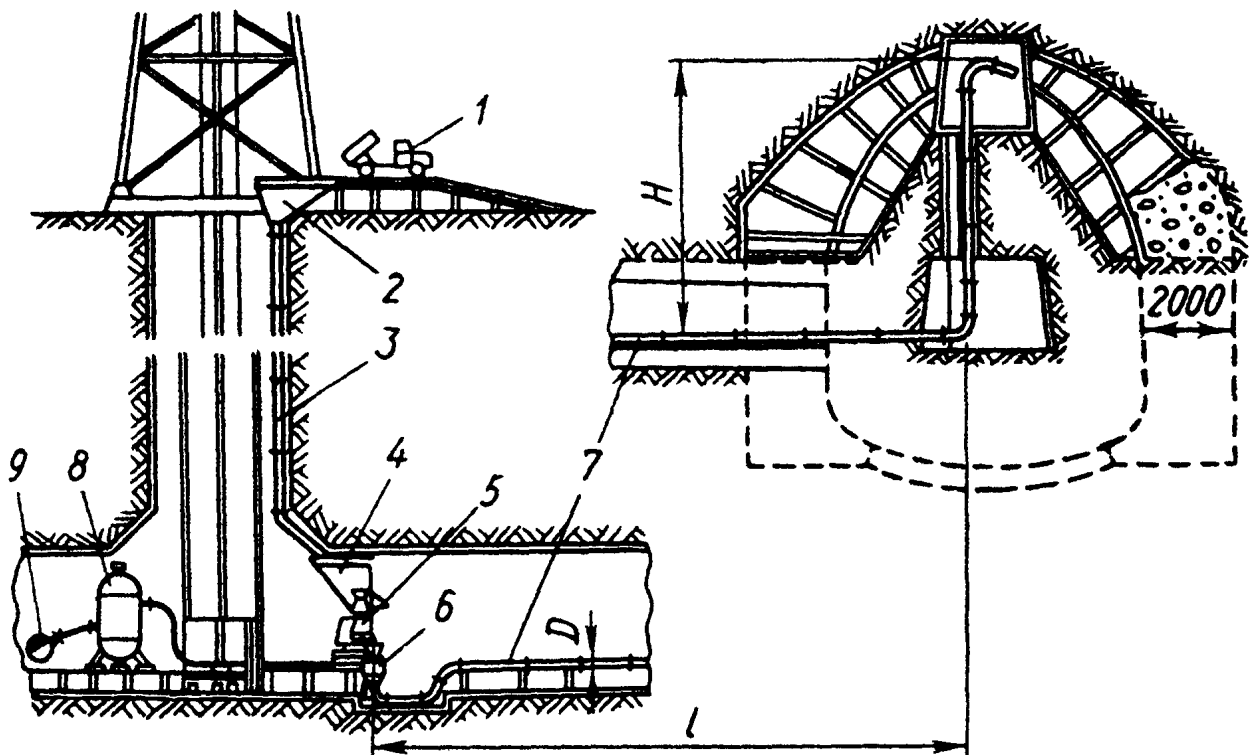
Схема II. Пневмотранспортна установка для бетонування підземних споруд: 1- автосамоскид; 2- верхній бункер; 3- рукав вертикального спуску бетону; 4- нижній бункер; 5- бетонозмішувач; 6- нагнітач; 7- бетонопровід; 8- ресивер; 9- центральний повітропровід.
